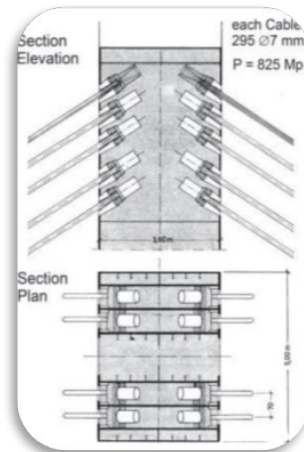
Anclaje en torre metálica para un arreglo en abanico modificado.
